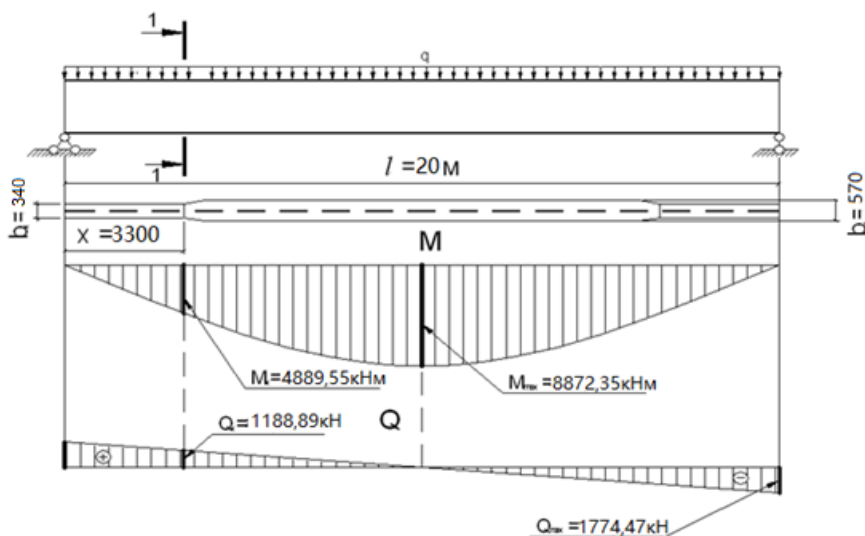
Расчетная схема к уменьшению сечения балки
